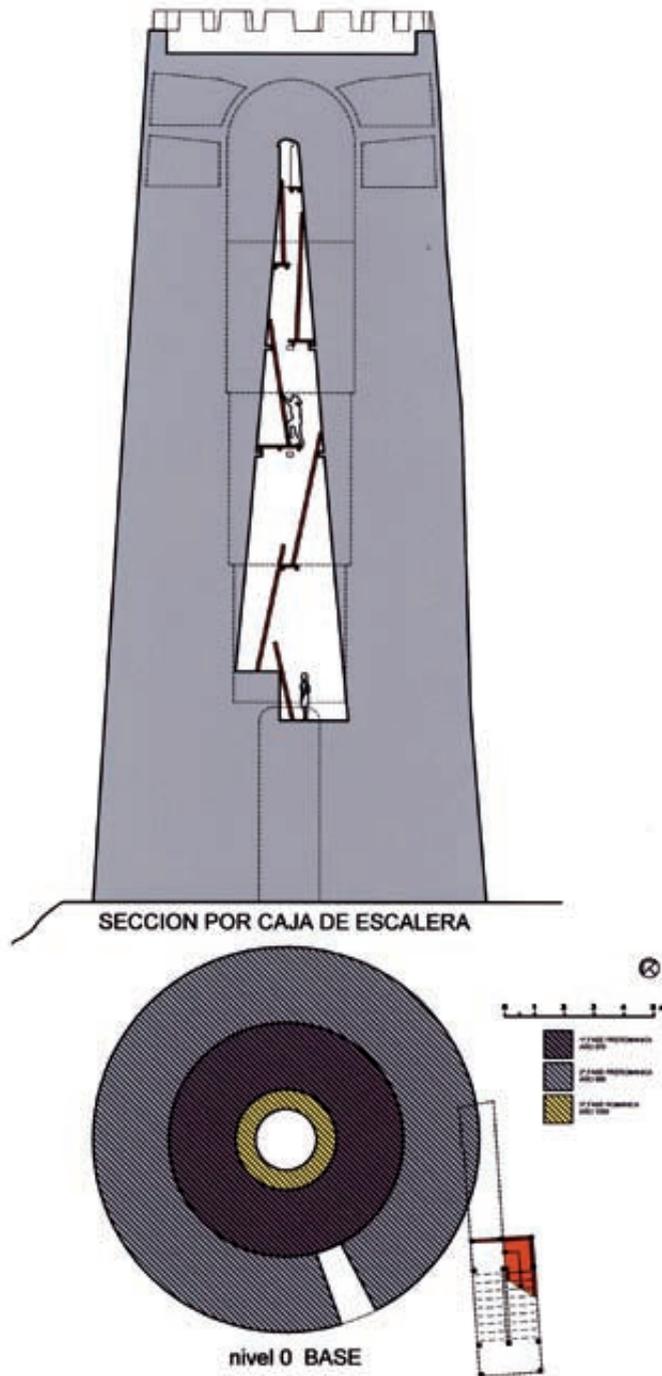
Plano de sección de la caja de escaleras con plano de planta del nivel 0 BASE.
